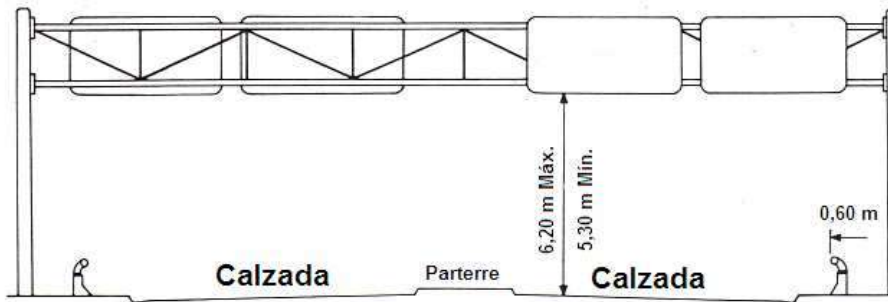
SOPORTE TIPO PÓRTICO
